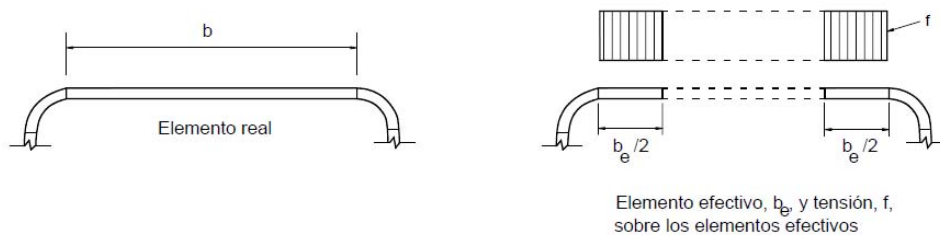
Elementos uniformemente comprimidos rigidizados por dos almas (alas del perfil C)
